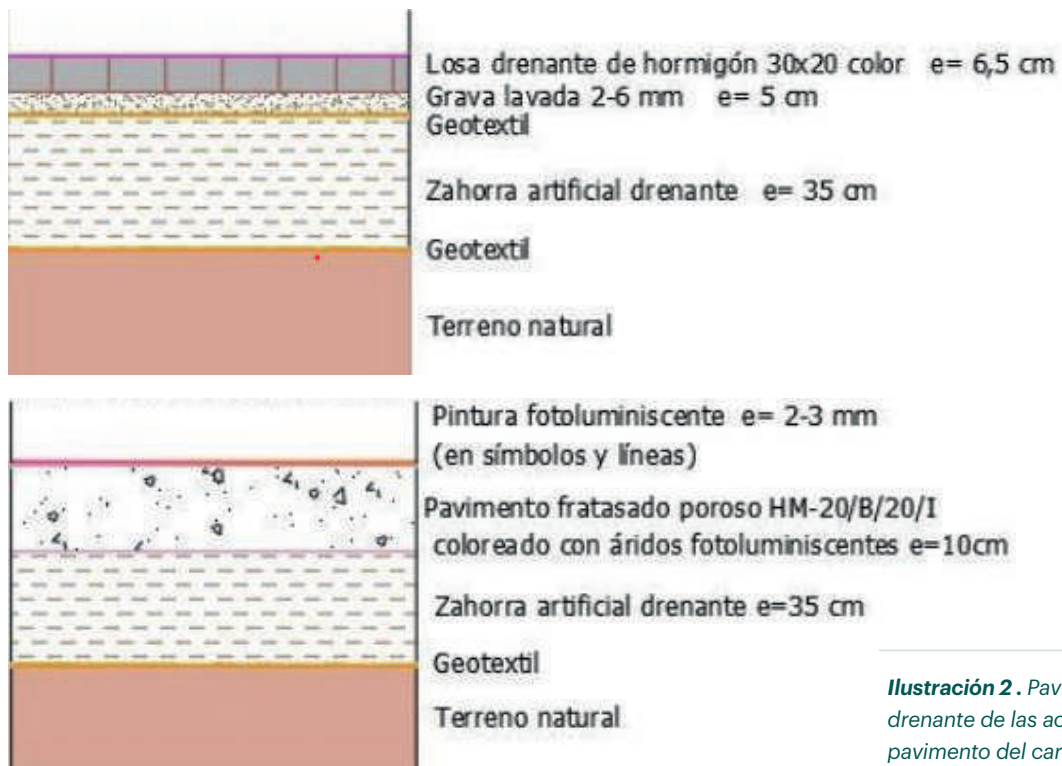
Pavimento drenante de las aceras (2) y pavimento del carril bici (3).
